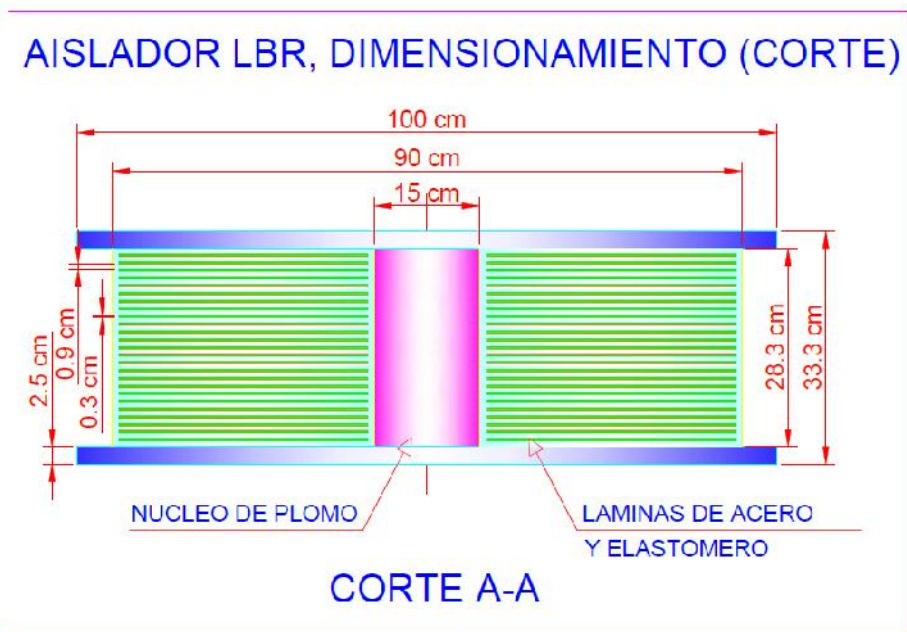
Aislador LBR, Dimensionamiento corte
